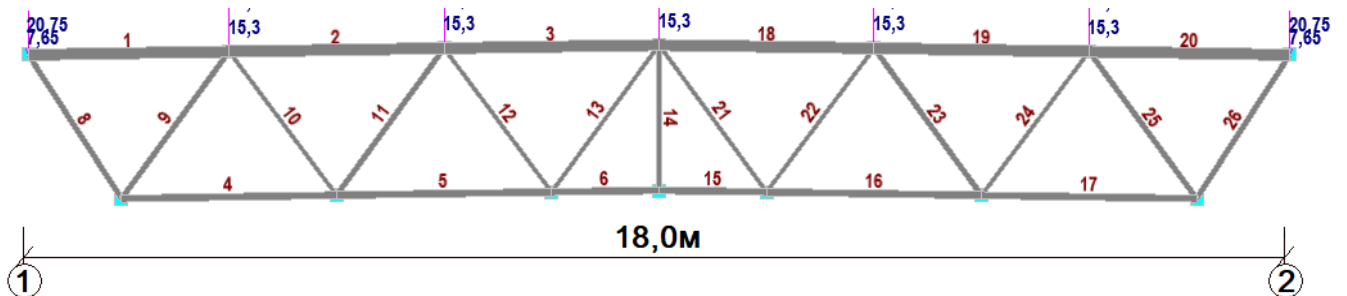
Расчетная схема фермы с приложением суммарной нагрузки (постоянная+снег) в программном комплексе «СКАД» с номерами элементов фермы
